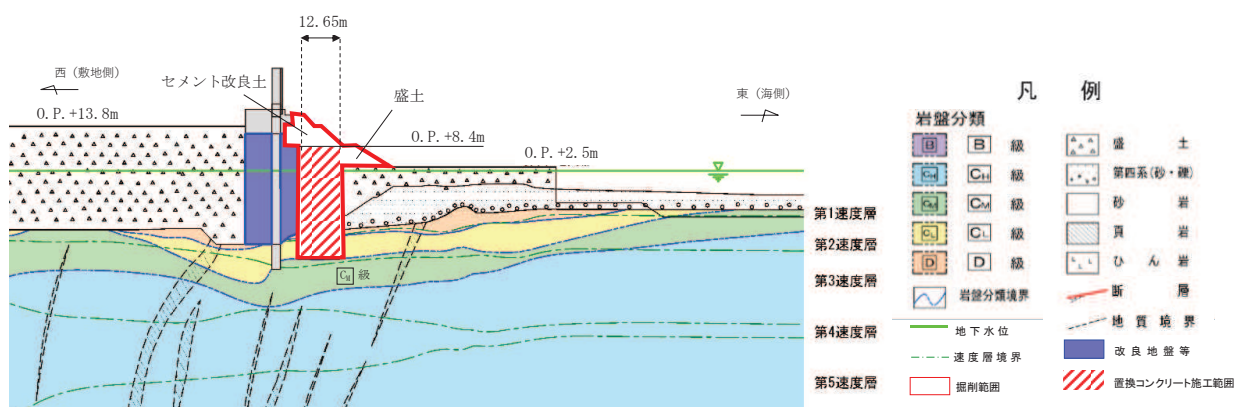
(2) 置換コンクリートの施工範囲図（断面図）
